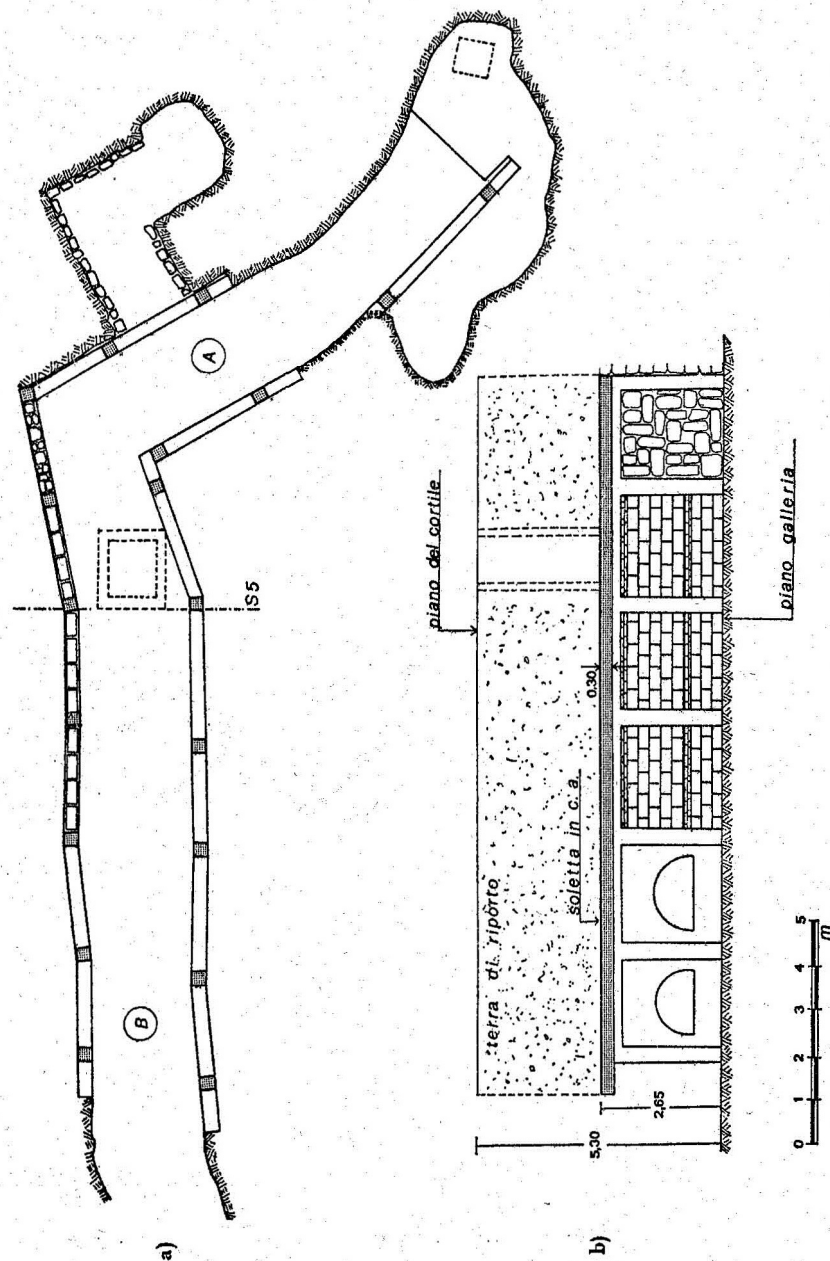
Pianta dei pilastri e delle murature di tamponamento (a) e sezione longitudinale (b).
